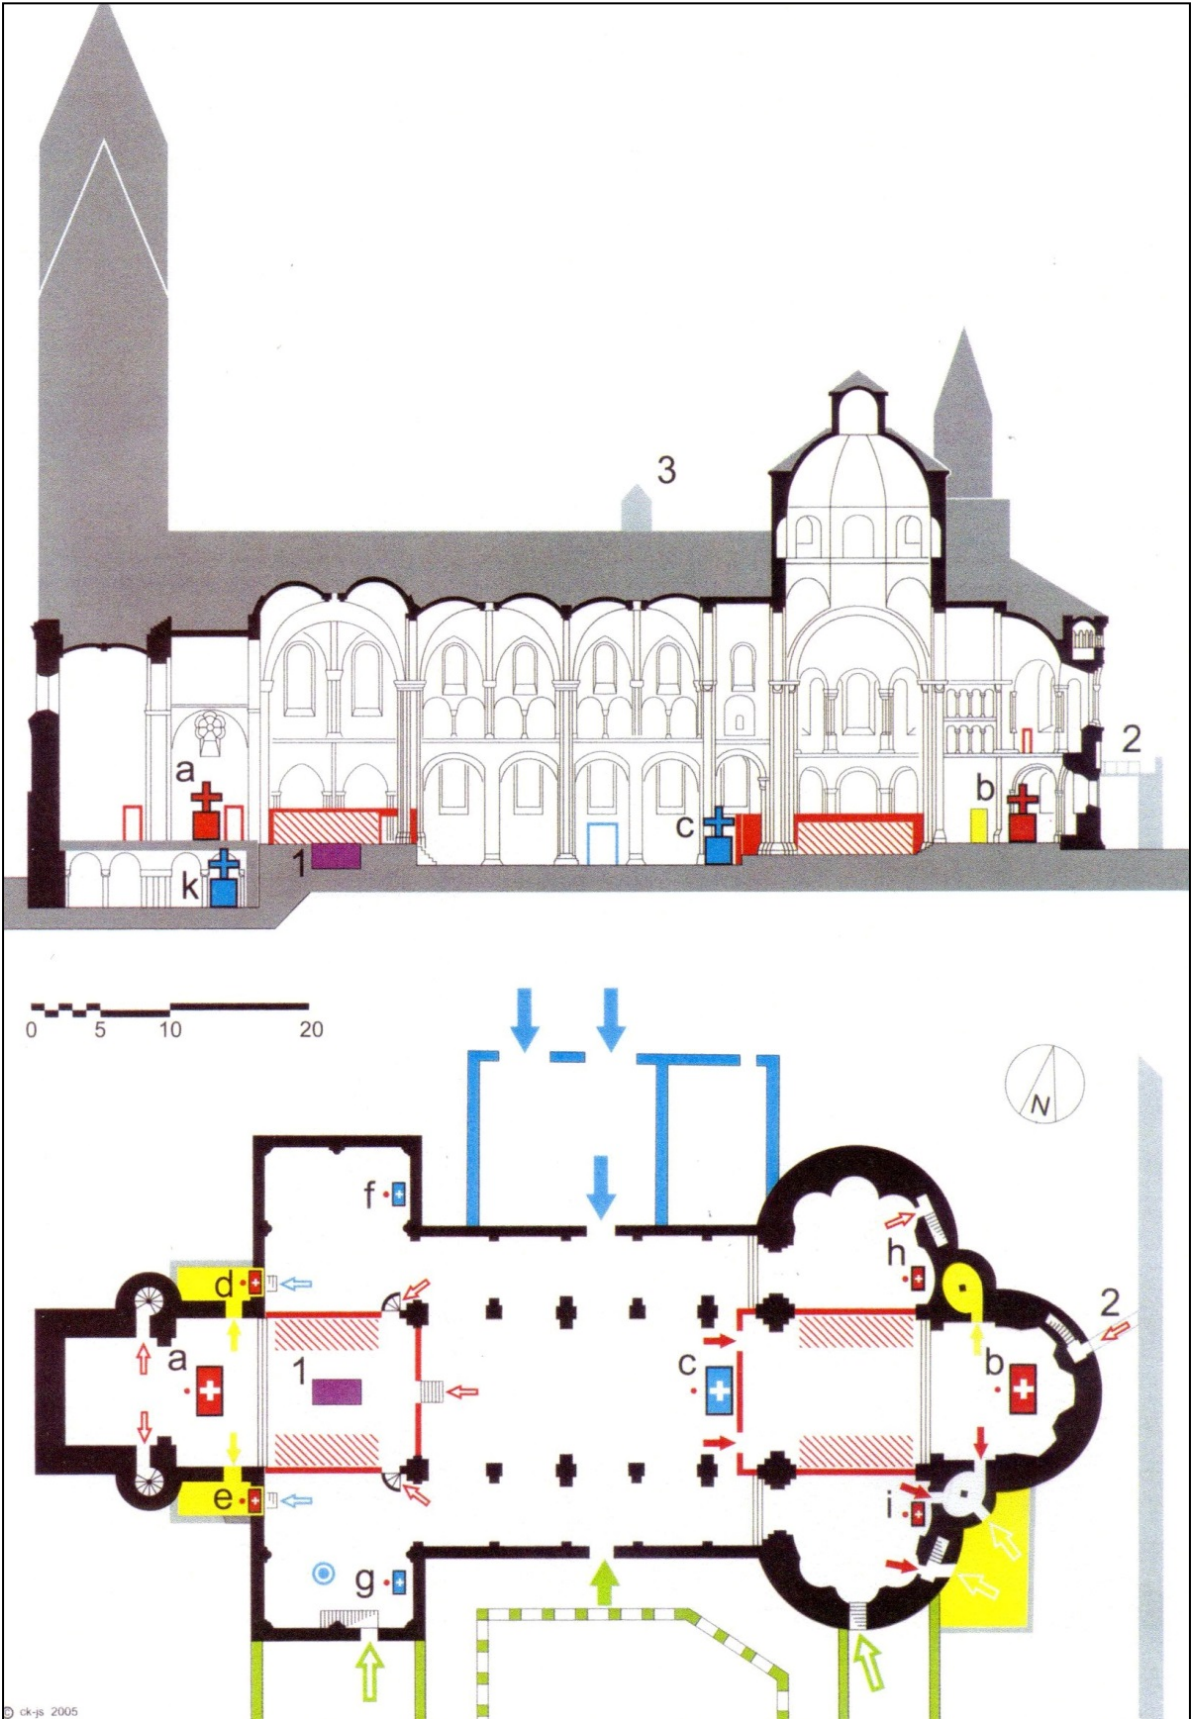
Grund- und Aufriss von St. Aposteln in Köln mit Doppelchor
